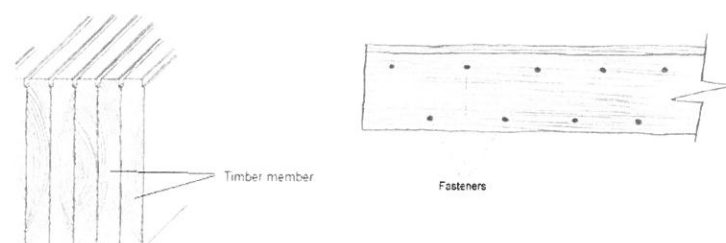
Elemento estrutural para edifícios constituído por peças de madeira de seção retangular ligadas por pregos ou parafusos – EAD nº 130011-00-0304
